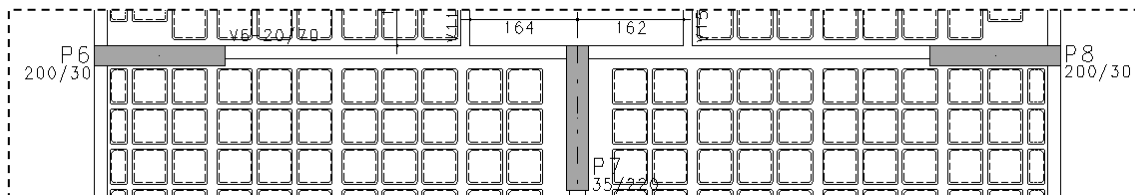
Trecho da planta baixa de forma – Edifício 2
